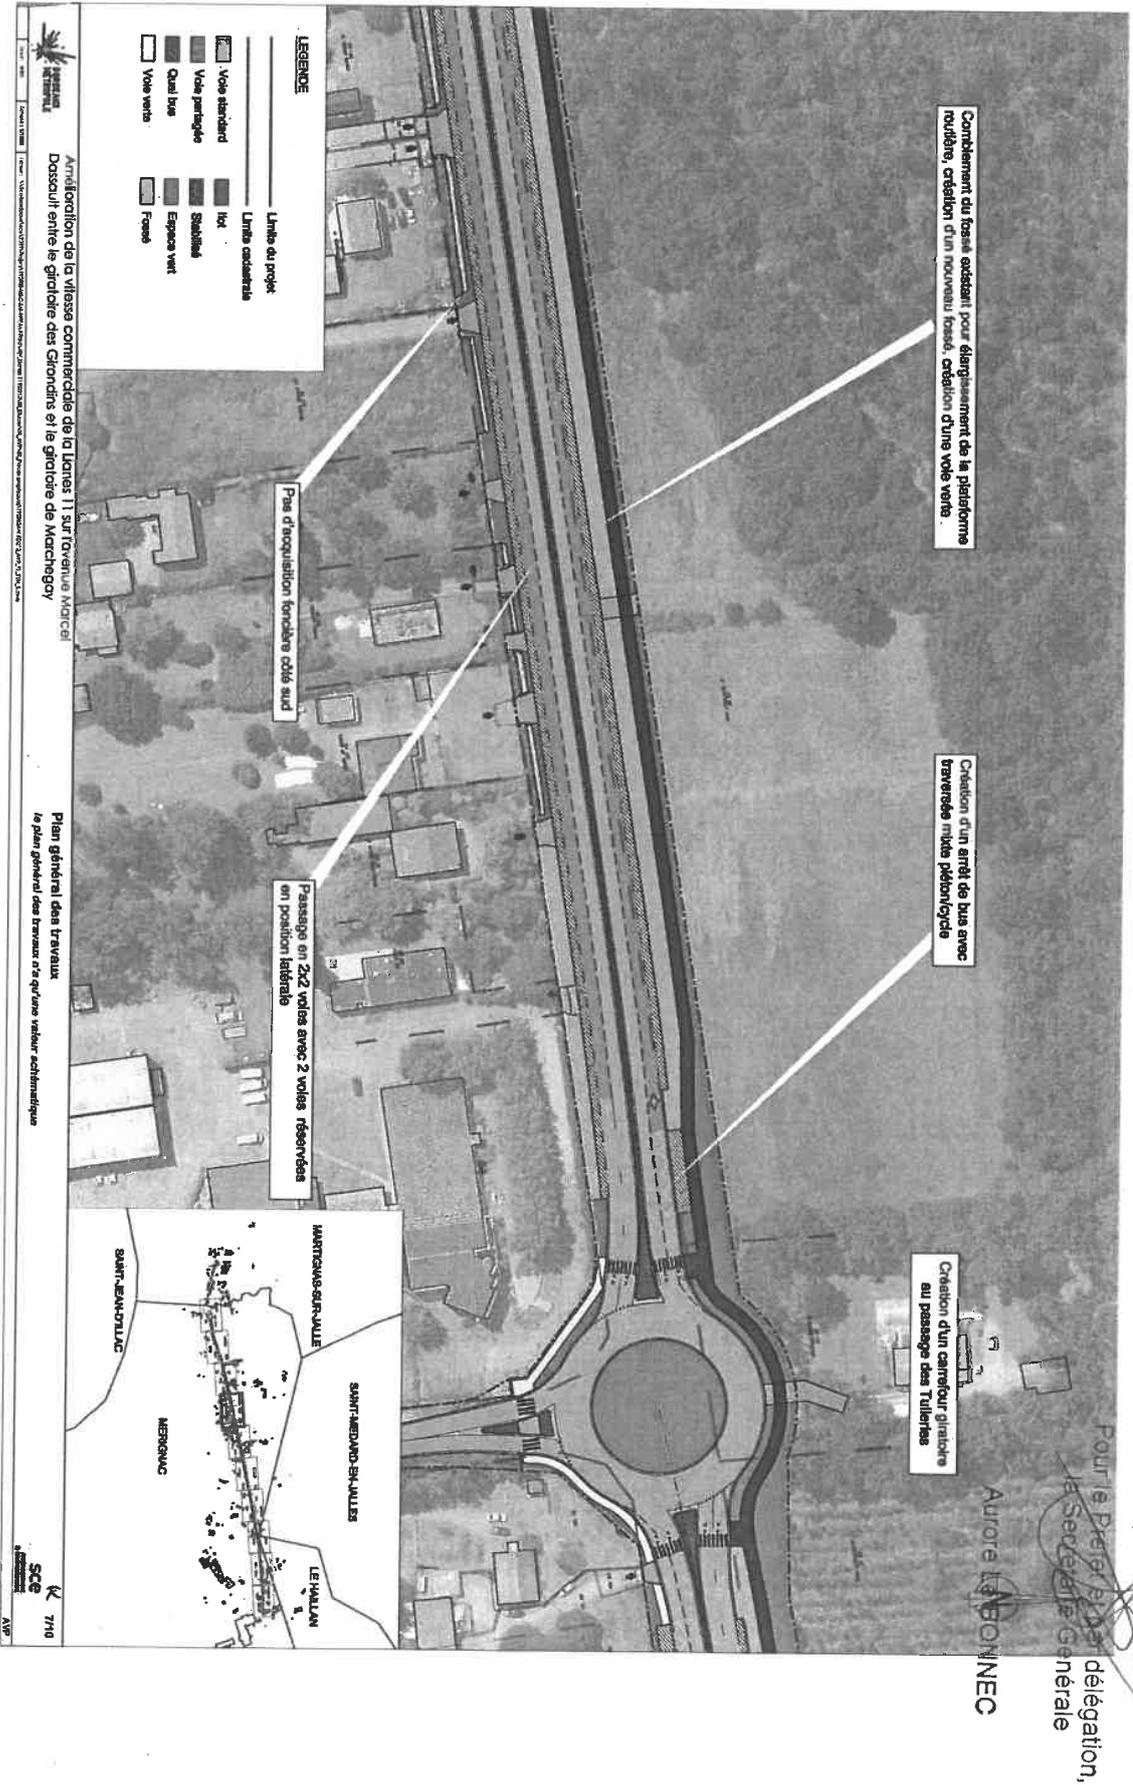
Plan Général des Travaux 4. Source : Bordeaux Métropole
